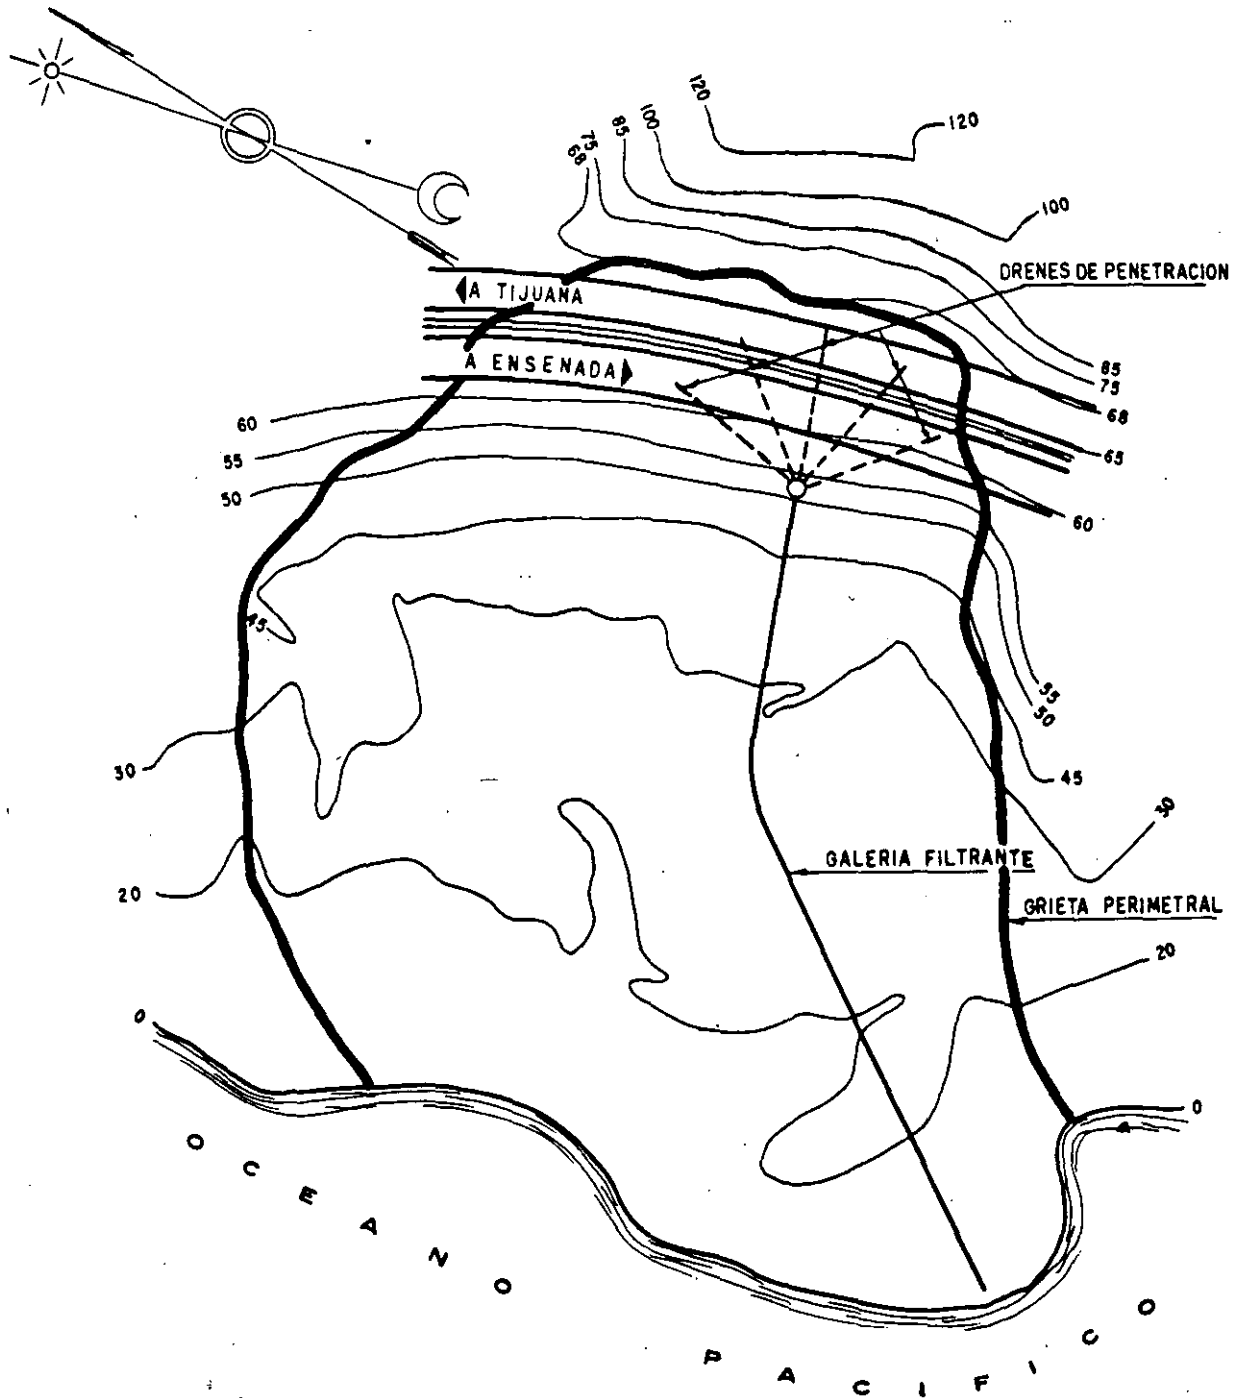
Planta de la galería filtrante construida en el km 19 + 200 de la autopista Tijuana-Ensenada (Ref. 30).
